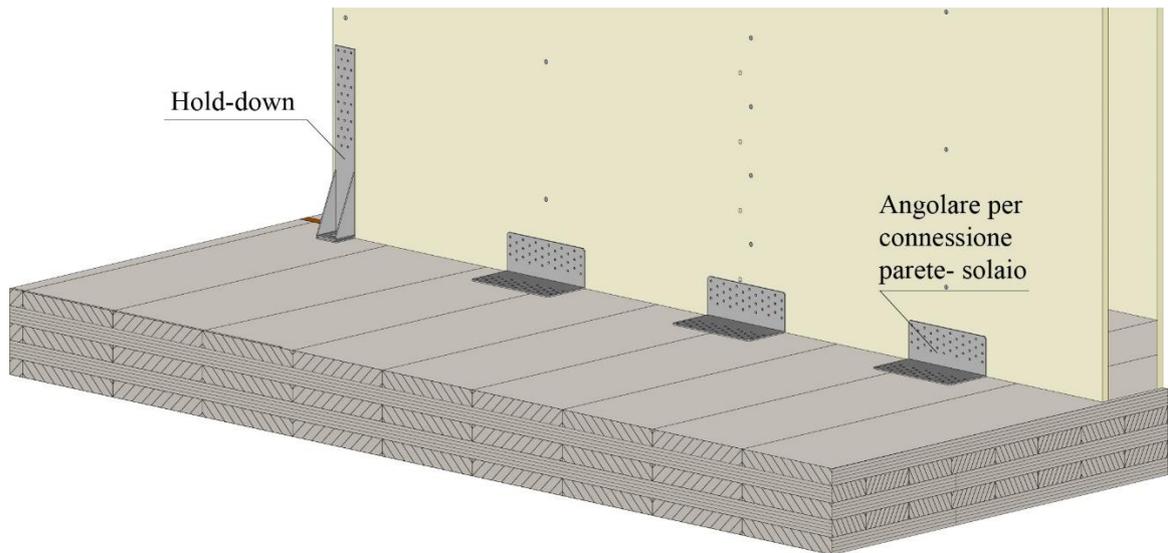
Staffe hold-down e piastre angolari impiegate per il collegamento con il sistema di fondazione
